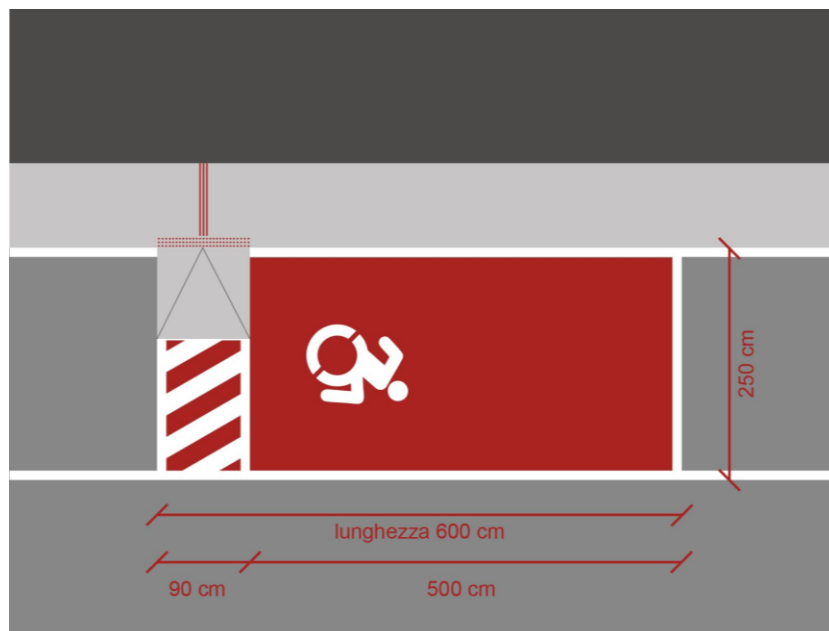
Schema planimetrico che illustra la progettazione di un parcheggio parallelo accessibile alle persone con disabilità, con indicazione delle dimensioni minime richieste. Evidenzia inoltre la necessità di un collegamento sicuro al marciapiede, tramite una rampa, e la presenza di pavimentazione tattile per facilitare l'identificazione del posto auto riservato da parte di tutti gli utenti (Opera degli autori).
